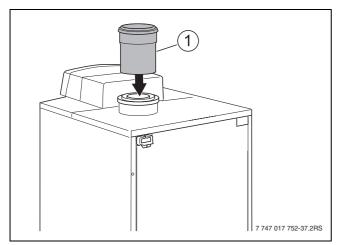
Montaggio del raccordo di collegamento della caldaia
